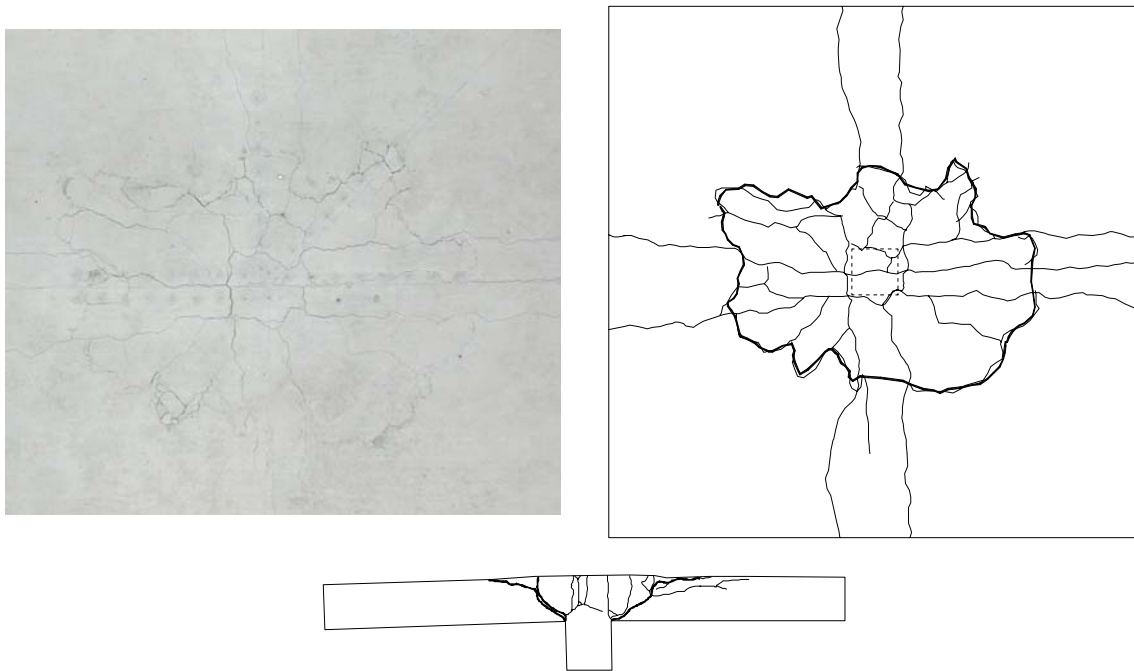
PG-4 : Fissures face supérieure (N en haut) et coupe NS
